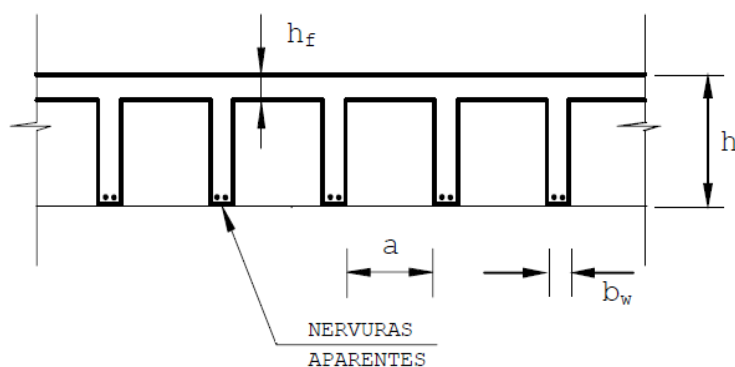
Laje nervurada com as células aparentes. (BOCCHI JR & GIONGO, 2010).
